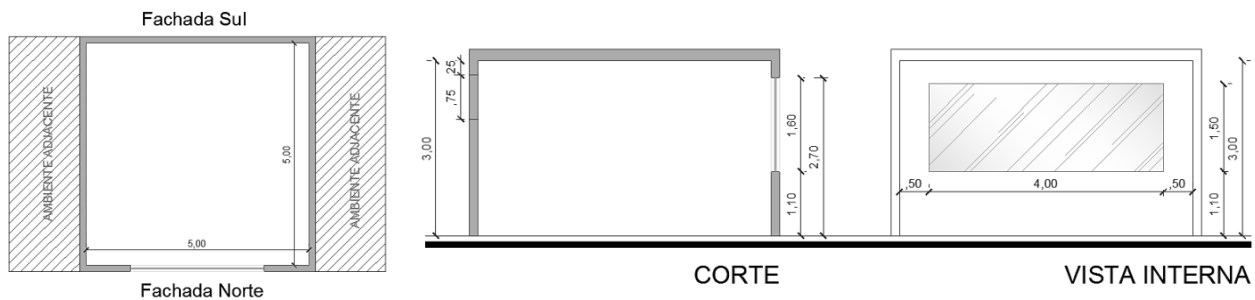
Planta baixa, corte e vista interna do ambiente analisado (PAF 40%).
